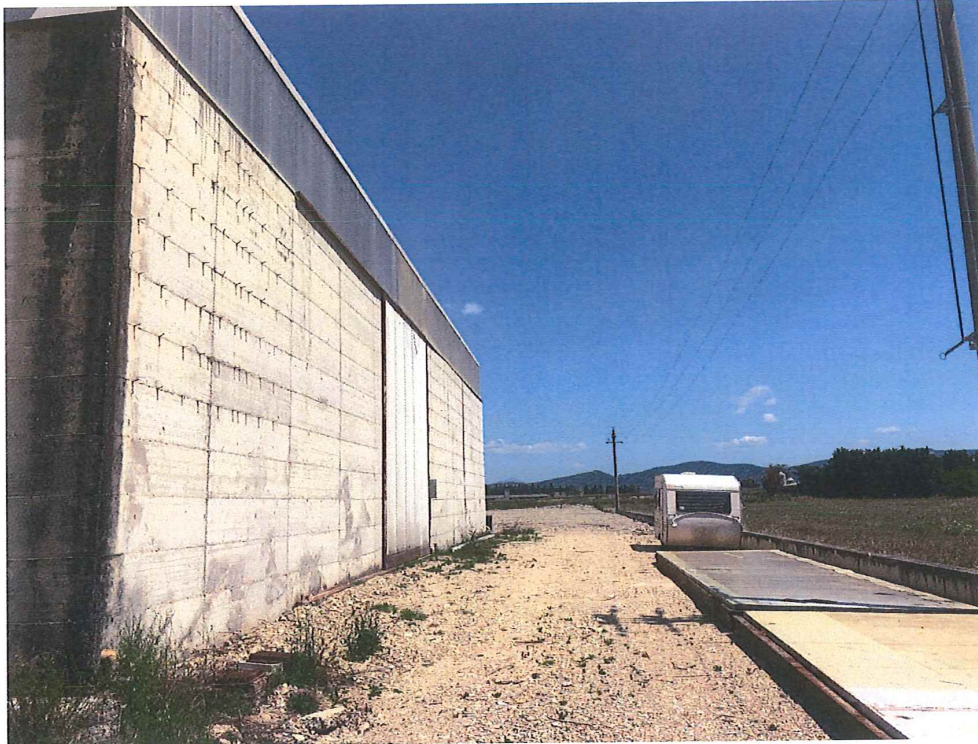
Bettona. Prospetto laterale sud-est.
